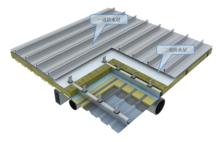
金属屋面双道防水体系 Fig.6 Double waterproofing system for metal roofing
